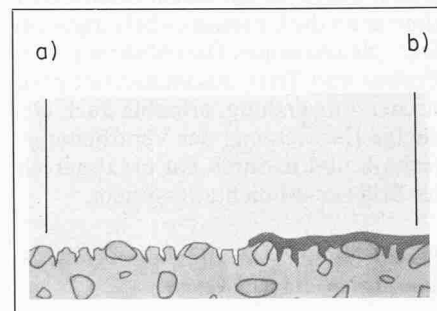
a) Beton gereinigt mit Hochdruckwasserstrahl
